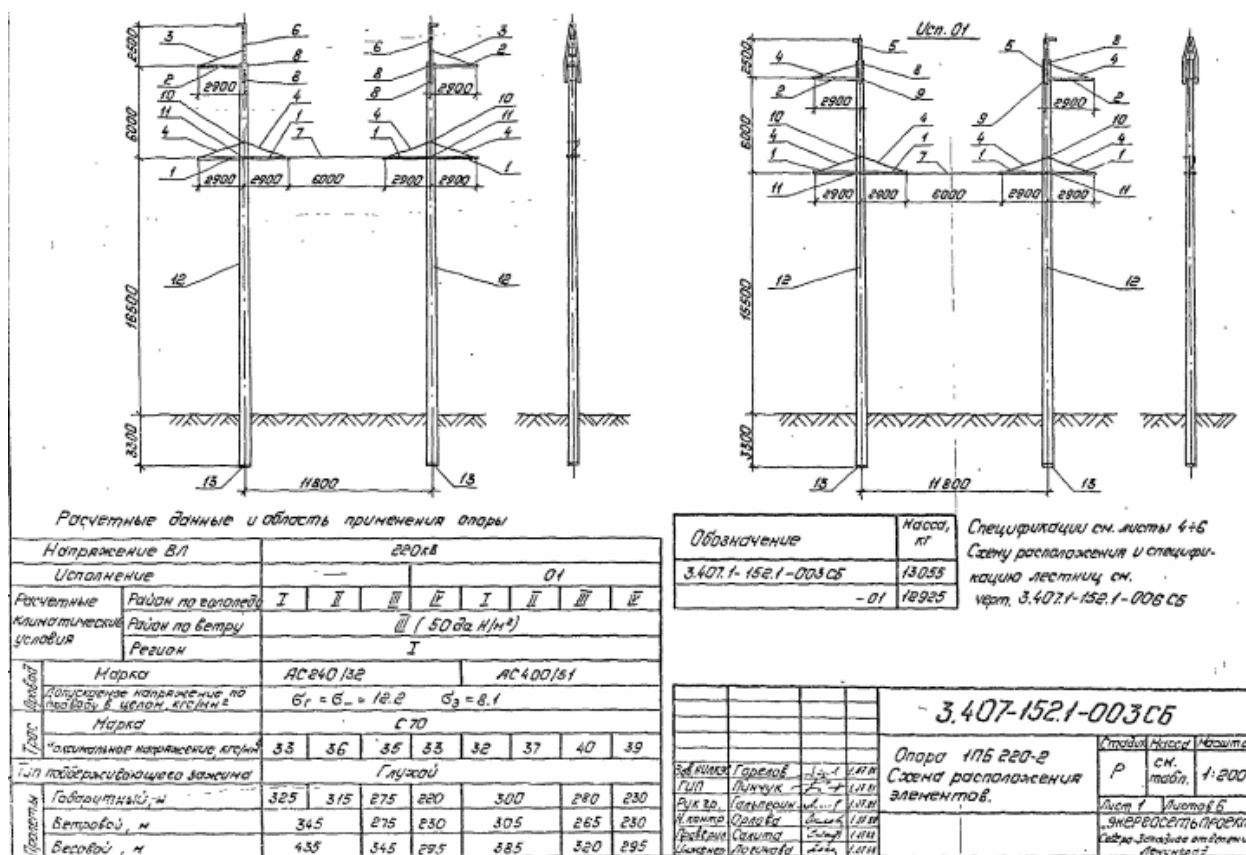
Схема элементов железобетонной опоры ЛЭП
